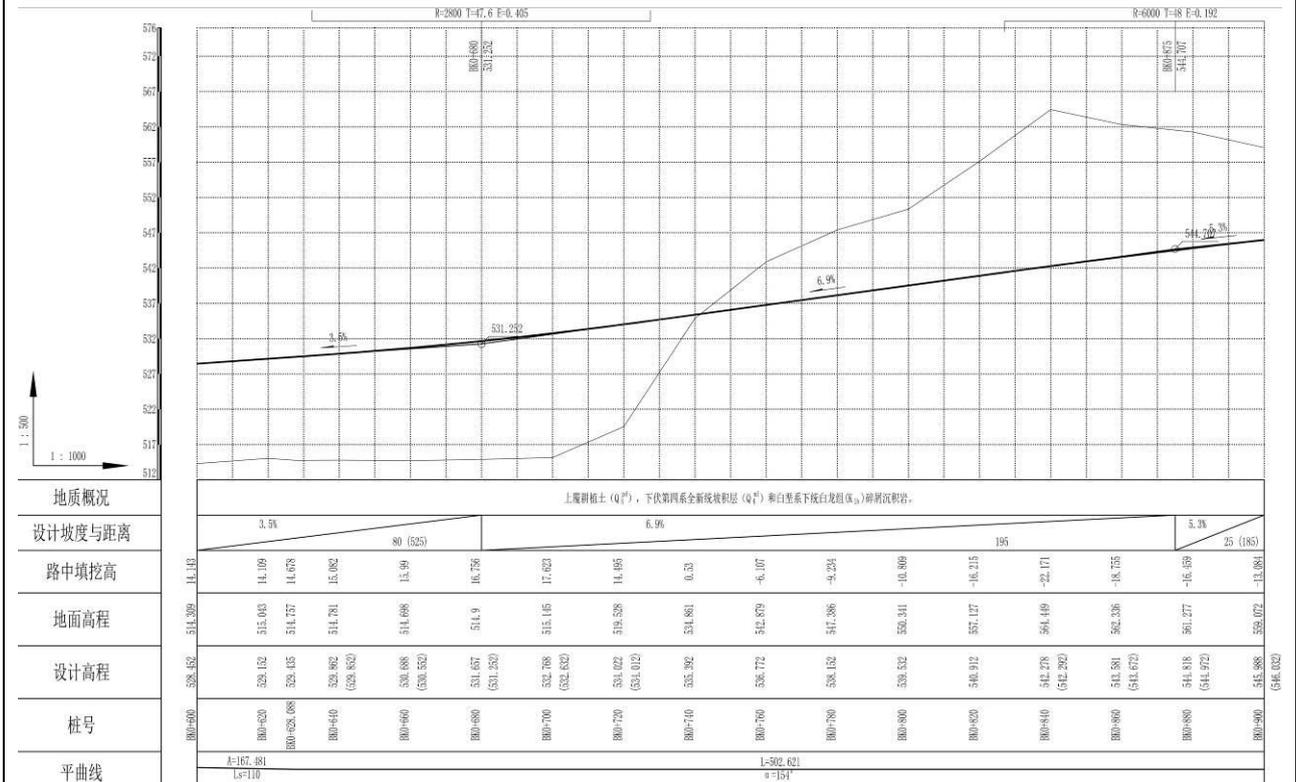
BK0+600~BK0+900 路段纵断面示意图
